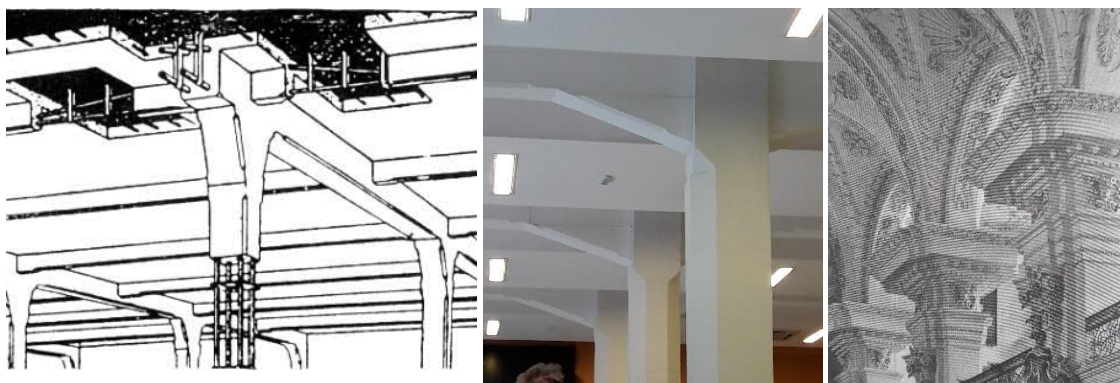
Hennebique, junta monolítica de concreto armado, patenteada em 1892. Fonte: Frampton,1979, p.34
